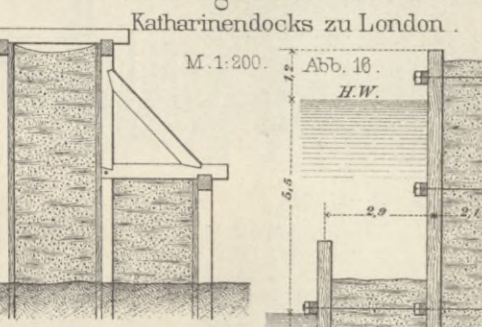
u. 16. Fangdämme vom Bau des Katharinendocks zu London.
